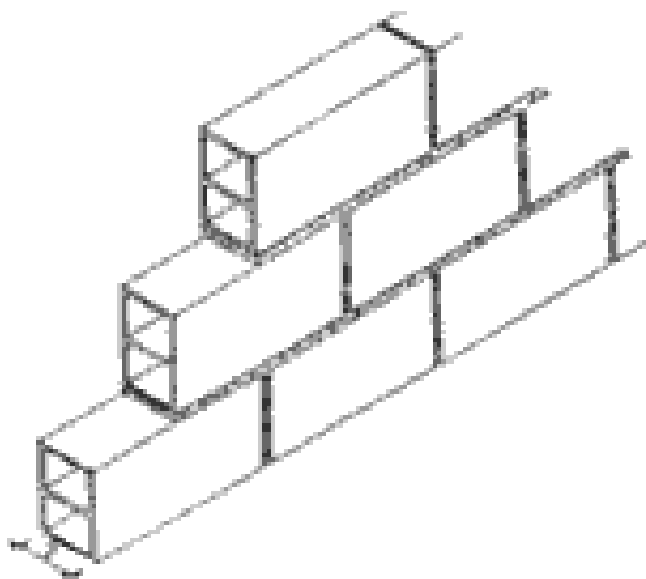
Esquema construtivo de parede em tijolo ao cutelo
